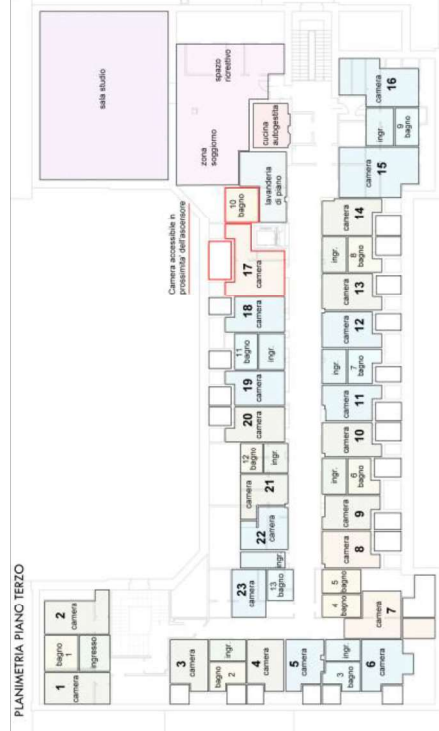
Planimetria del piano terzo, conteggio delle camere e divisione degli ambienti.
